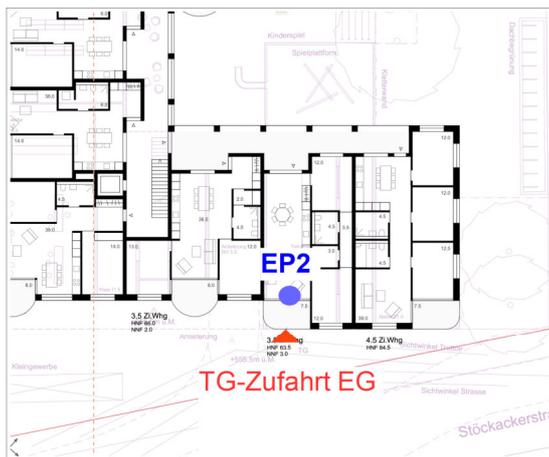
Grundriss 1.OG – Empfangspunkt EP 2 Gebäude I.1, 1.OG
